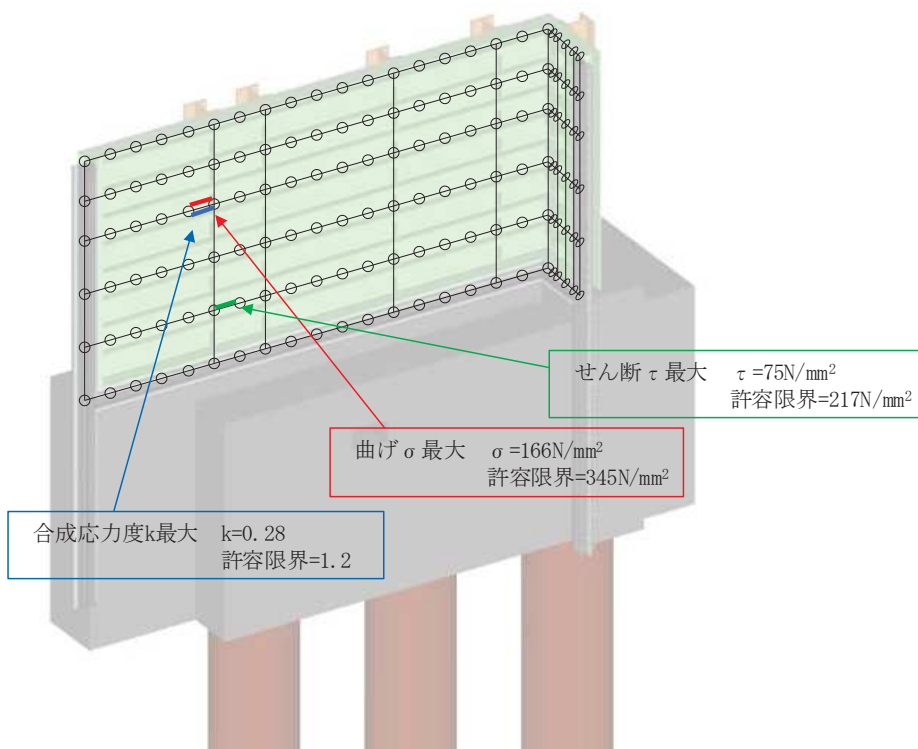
鋼板の曲げ・軸力系の破壊及びせん断破壊に対する
